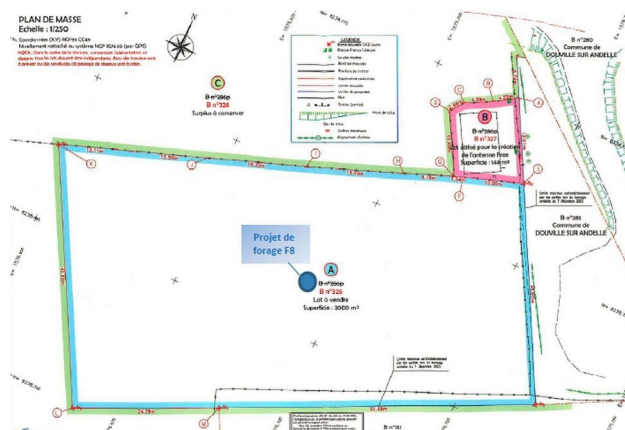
Plan d'implantation du forage F8 dans la parcelle cadastrée (source : fig. 3 p. 14 EI<sup>5</sup>).
